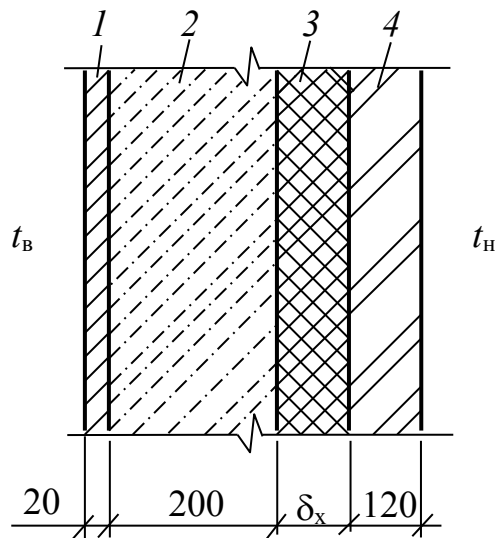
Вариант 2 конструкции наружной стены:
